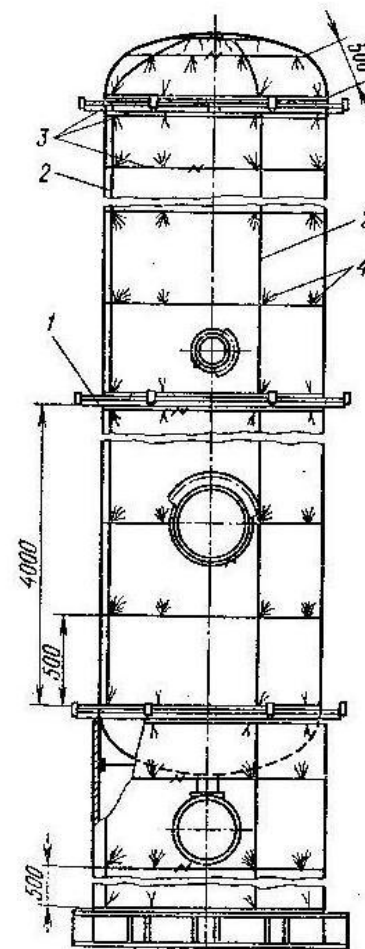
Крепление тепловой изоляции на проволочных стяжках:
